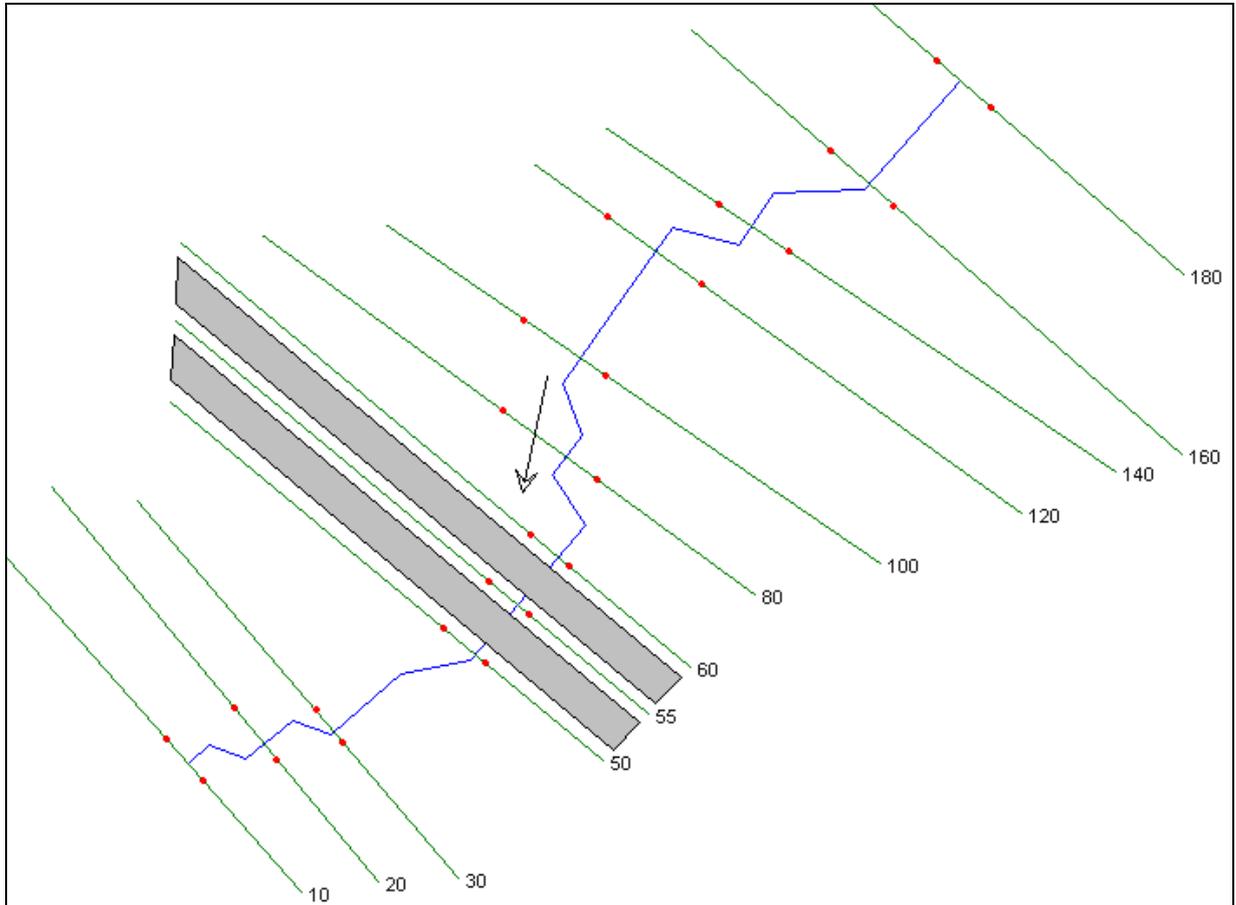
SCHEMA PLANIMETRICO DELLE SEZIONI USATE PER IL CALCOLO E POSIZIONE DEI DUE VIADOTTI IN PROGETTO
